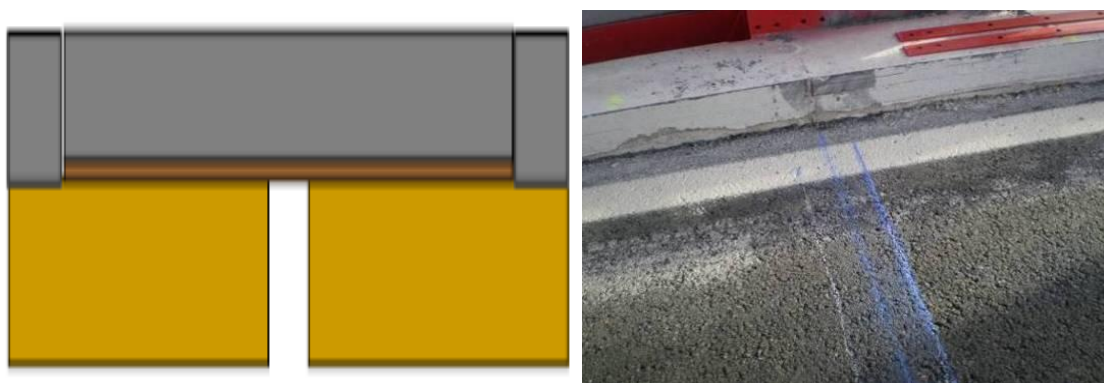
Corte do pavimento em esquema [38] e guias para corte do pavimento [37]
